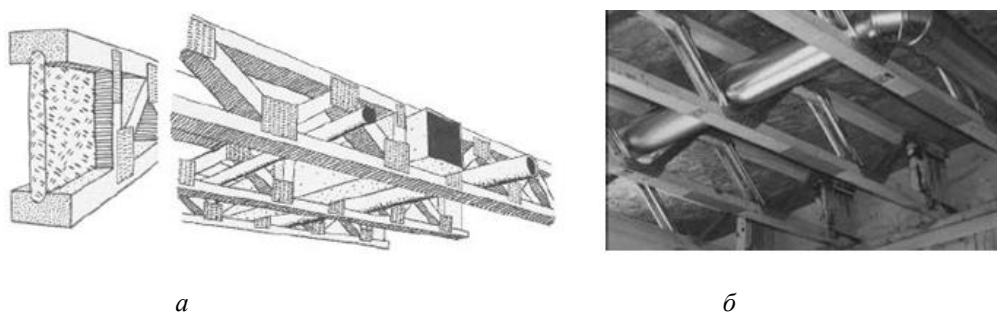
Конструкции ферм с использованием двутавров из древесного пластика: *а* – соединение конструкции металлическими пластинами (вид с разных сторон); *б* – комбинированное соединение
